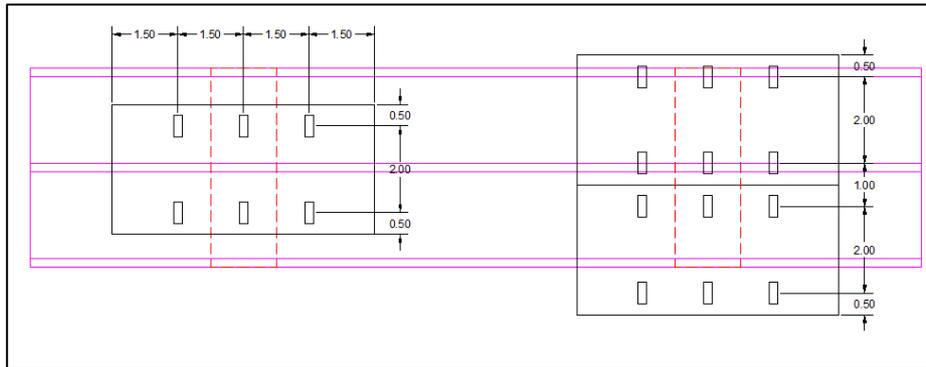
Carga móvel sobre a galeria - distribuição em planta do trem tipo.
